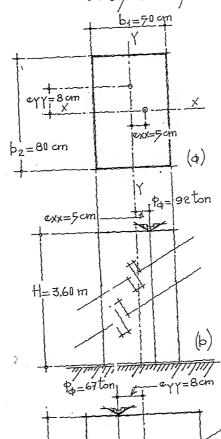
Planta de la columna mostrando la posición de las cargas excéntricas, (a).
